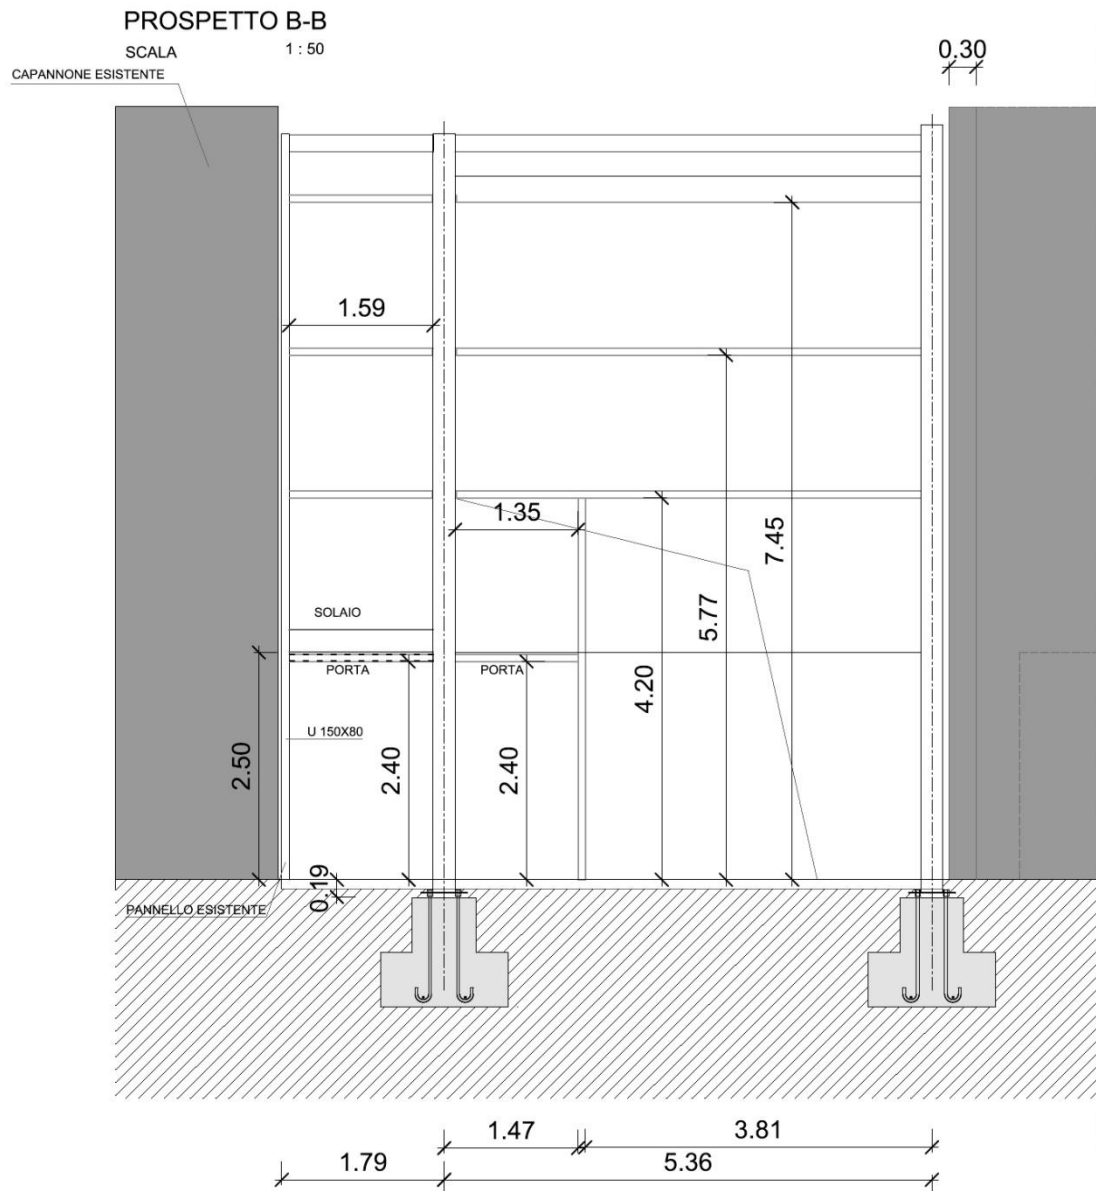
Particolare di A.2003.a.us.a.T01 - Struttura in acciaio - Prospetto Est
